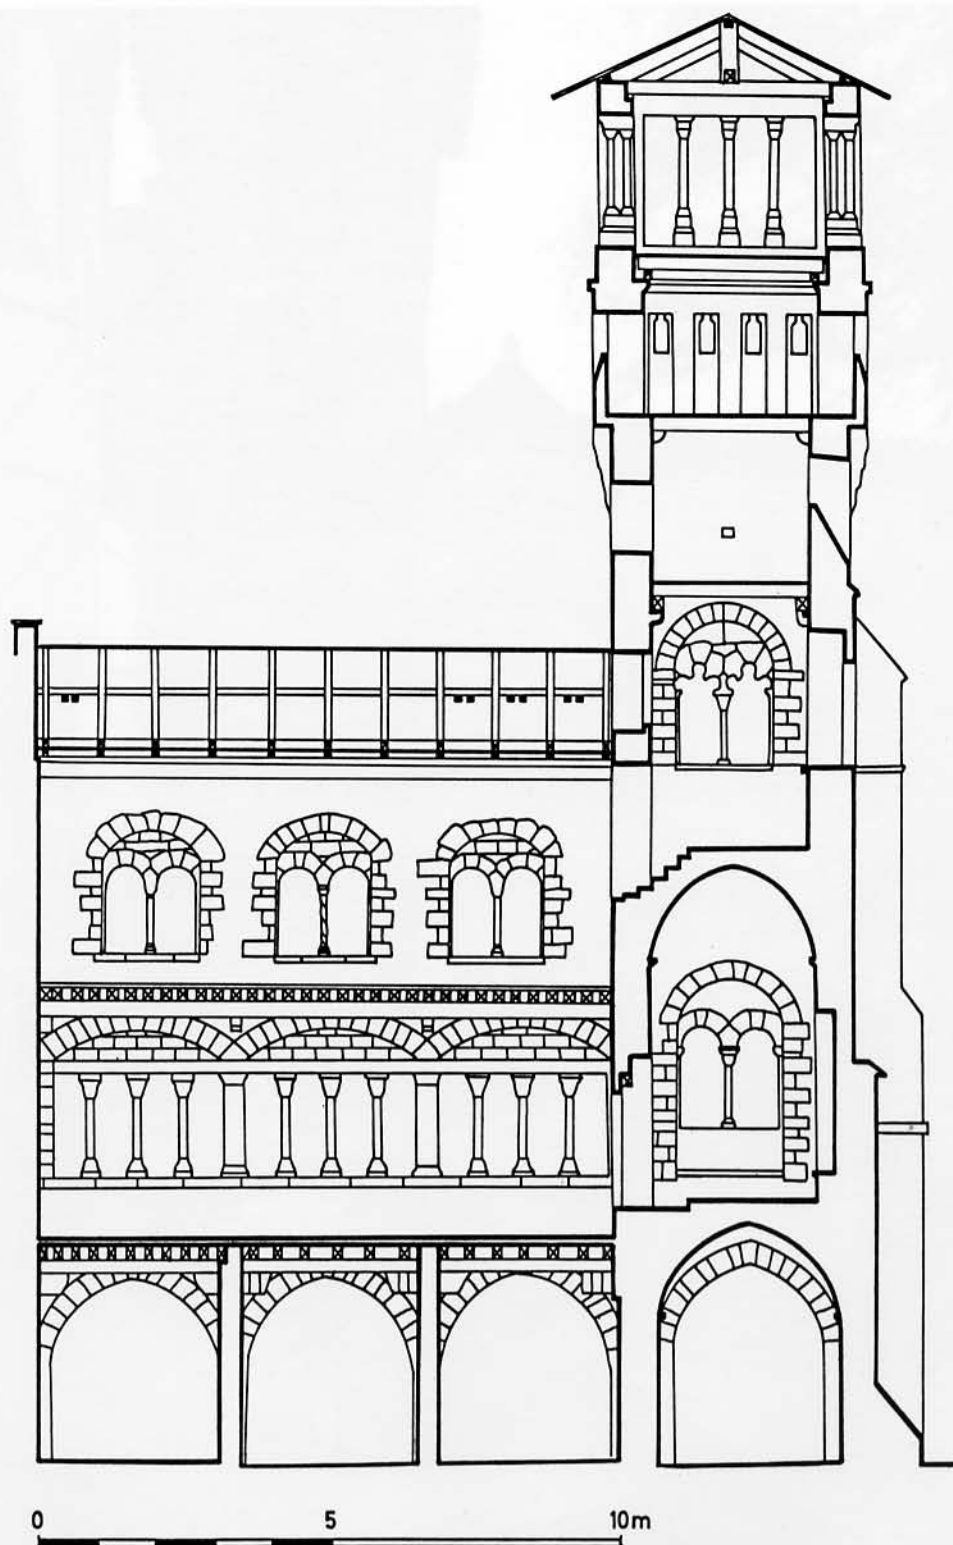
COUPE LONGITUDINALE NORD-SUD ET ELEVATION INTERIEURE DU MUR EST (Relevé P. Roques, Inventaire Général).
